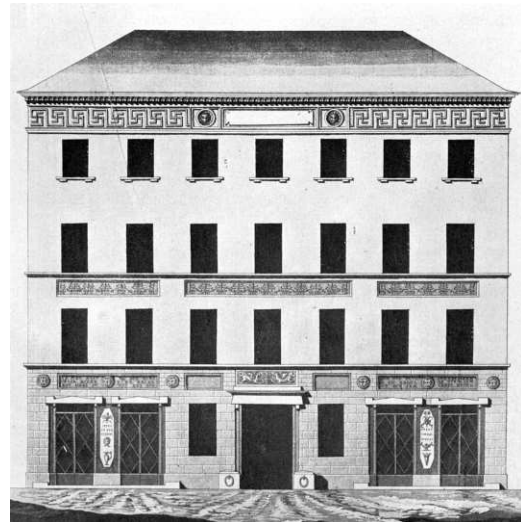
| Friedrich Gilly: Stadthaus Breite Straße 30, Berlin (ca. 1800).
